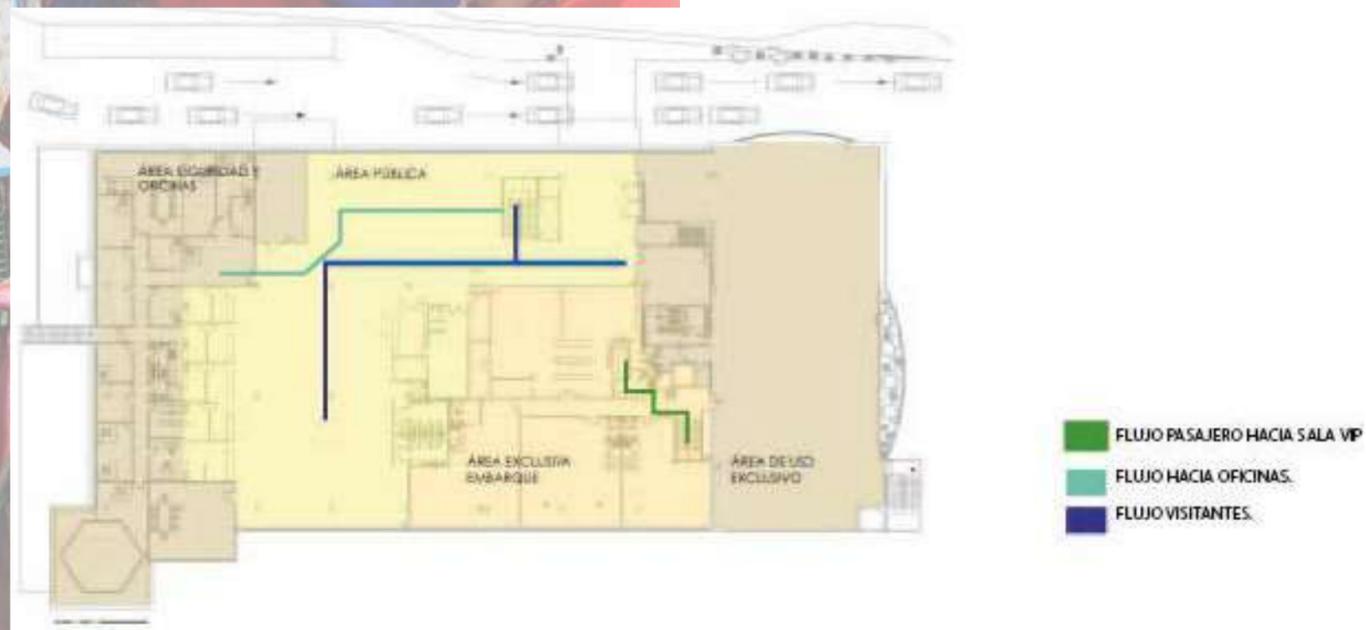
Planta Baja Plano de flujo de personas actual.
